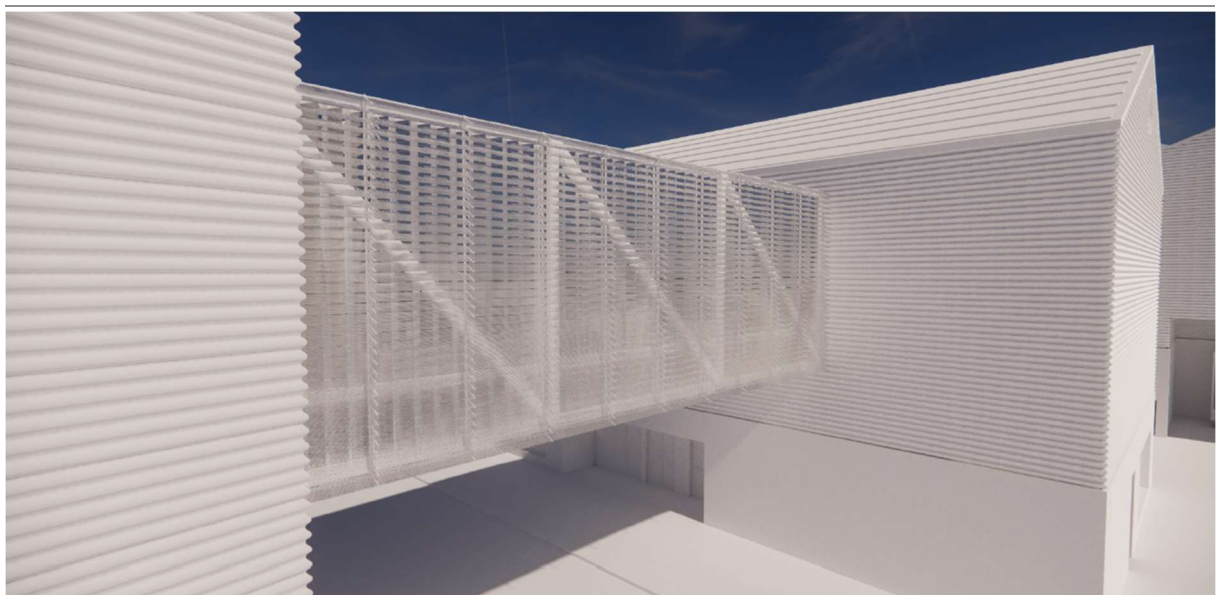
Visualisierung Detail Warenpasserelle mit Sandwich-Panel
